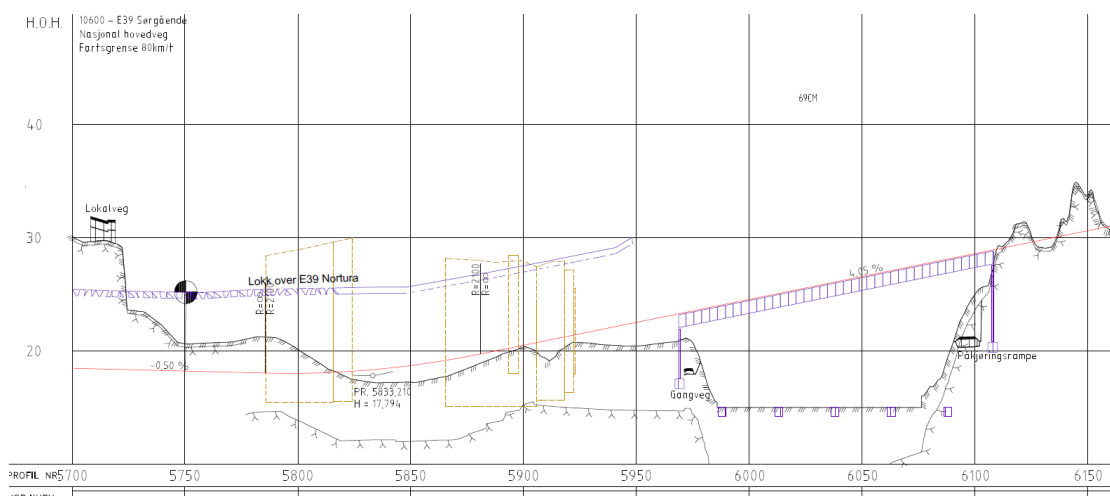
Viser plassering av forlengede vegtunnelportaler for Fløyfjelltunnelen over Norturatomten
